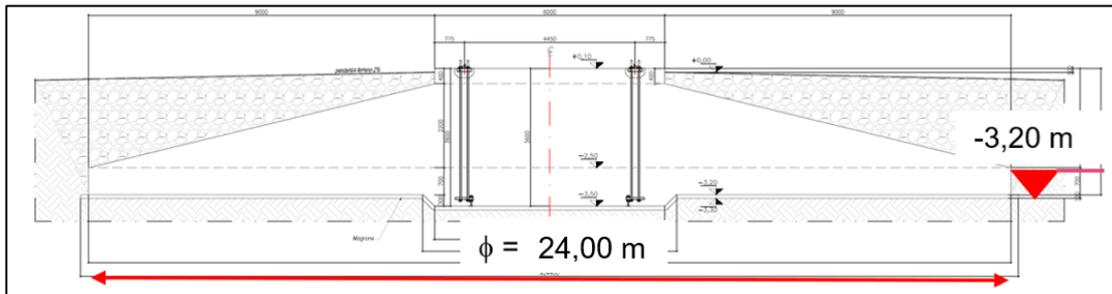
Fondazione diretta tipologica circolare ϕ 24 m per aerogeneratore HH=125 m R=155 m
